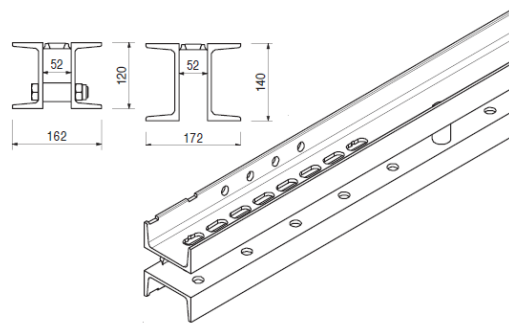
Elemento da estrutura de contenção de fachada: SRU. Retirado de [33]
